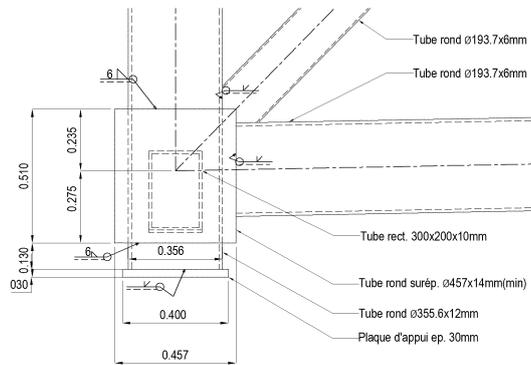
Passerelle Riviera-Palmeraie – Connexion type T/Y avec recouvrement
